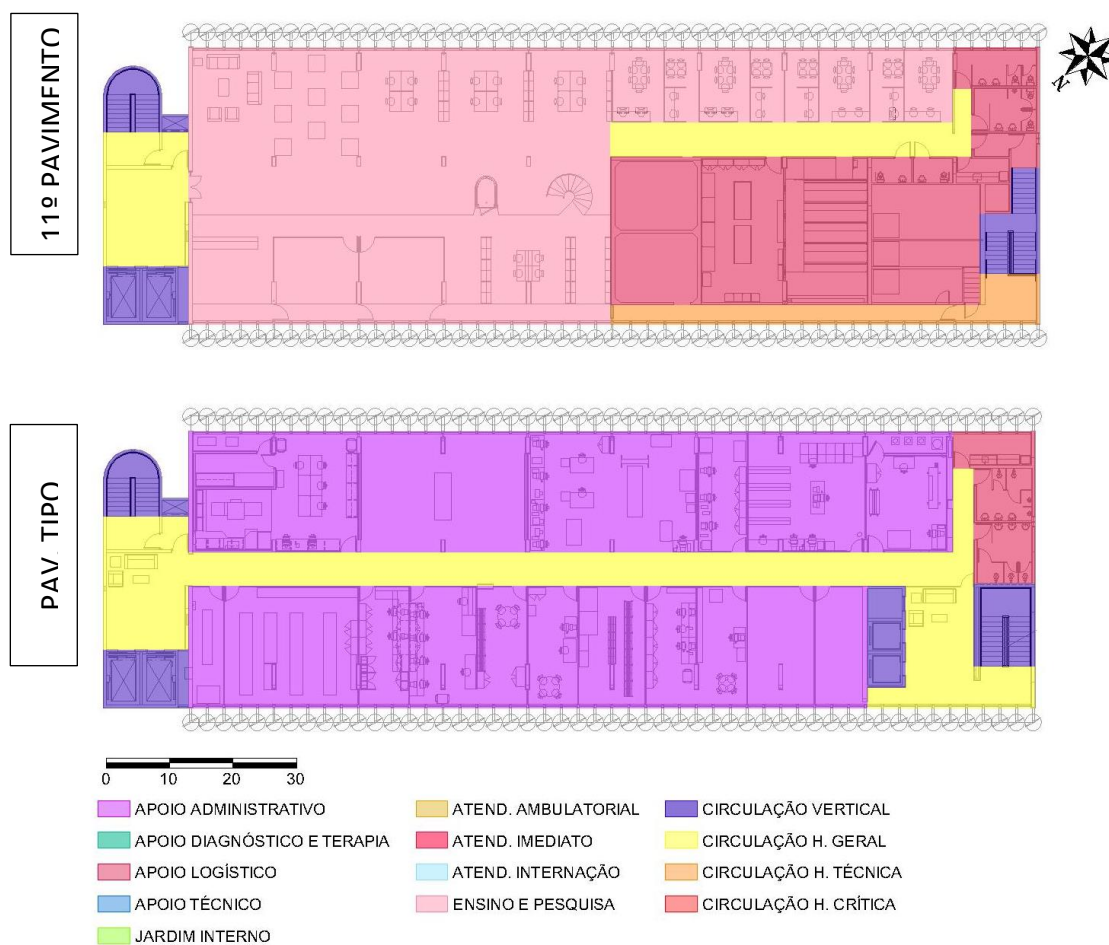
Setorização Edifício Sede, pavimento tipo 2º ao 11º pavimento.
